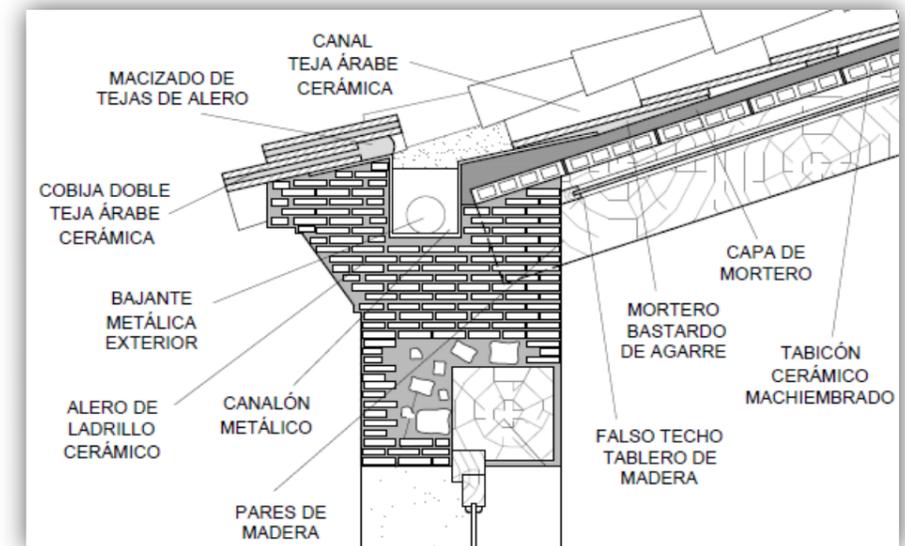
Detalle constructivo del encuentro entre el muro de cerramiento y la cubierta. 2014. Fuente: elaboración propia.
